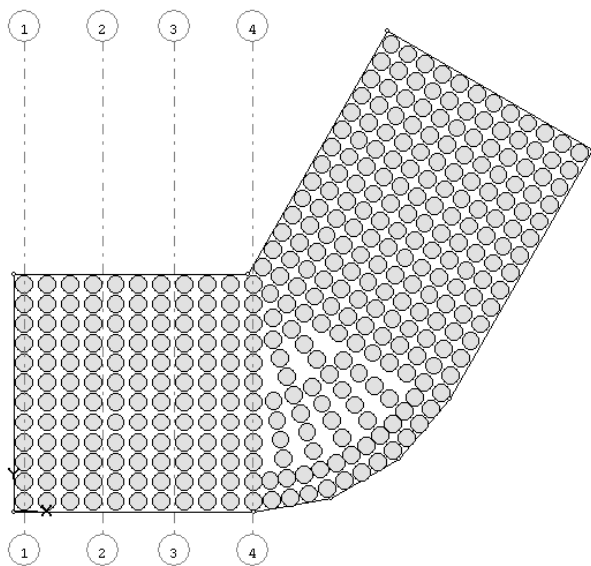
Фундаментная плита №1_1 на свайном поле
